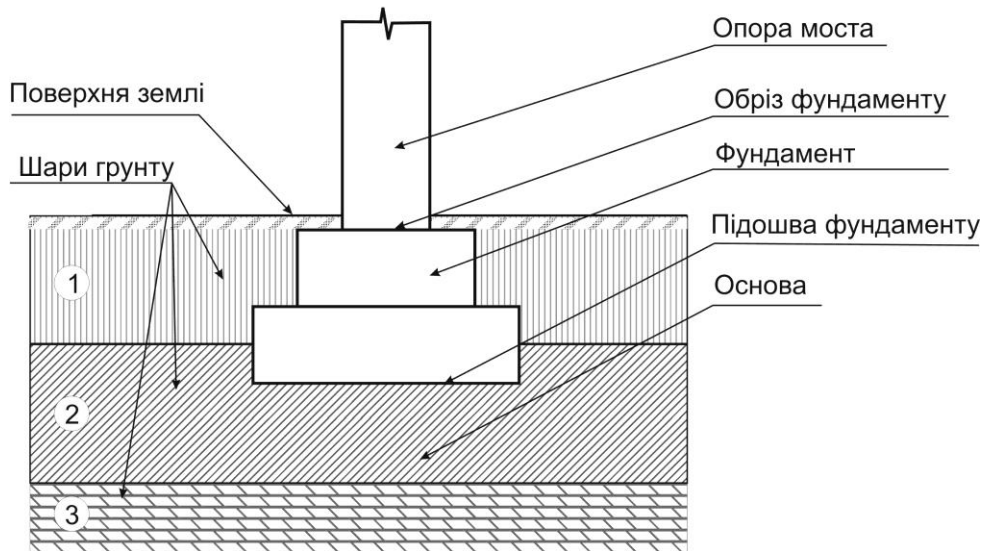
Фундамент неглибокого закладення (масивний) на суходолі (цифри 1,2,3 на цьому рисунку і наступних позначають шари ґрунту)
